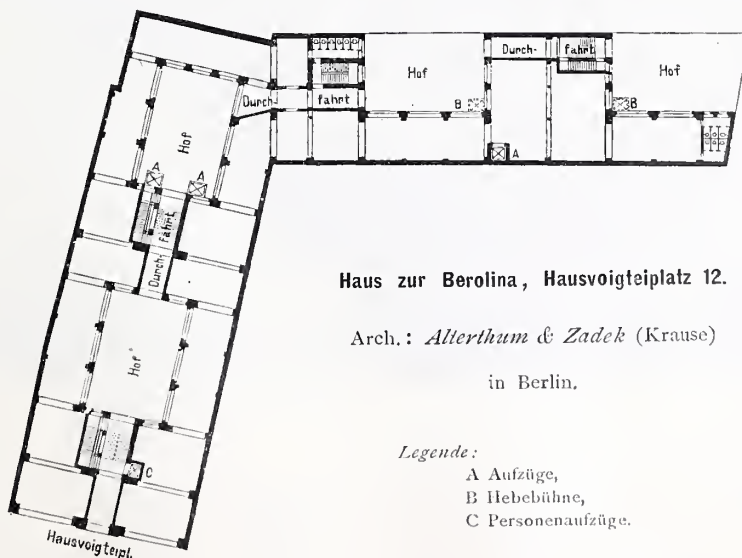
Erdgeschoss-Grundriss 1:1000.
